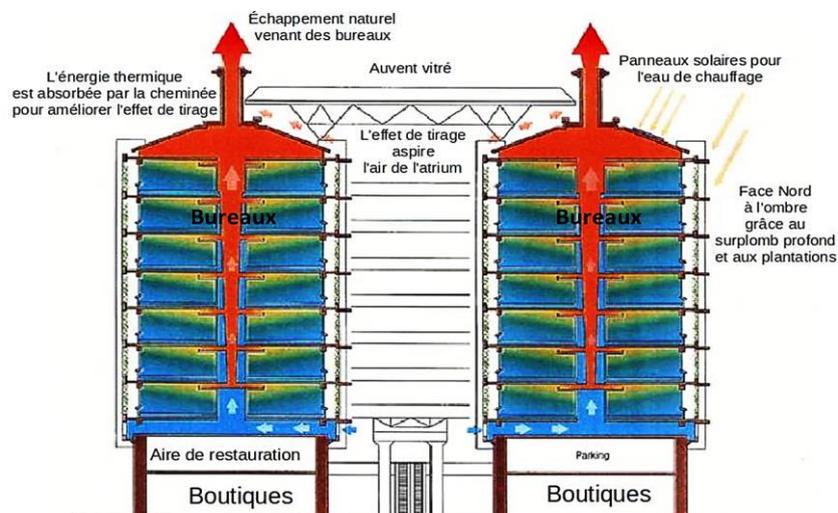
Coupe sur l'immeuble. (Source : TPE BIOMIMETISME)
